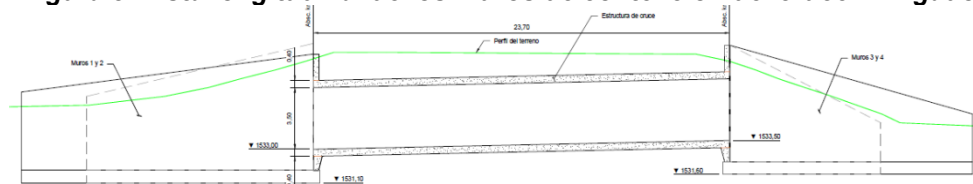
Vista en planta de los muros de contención del cruce Envigado
